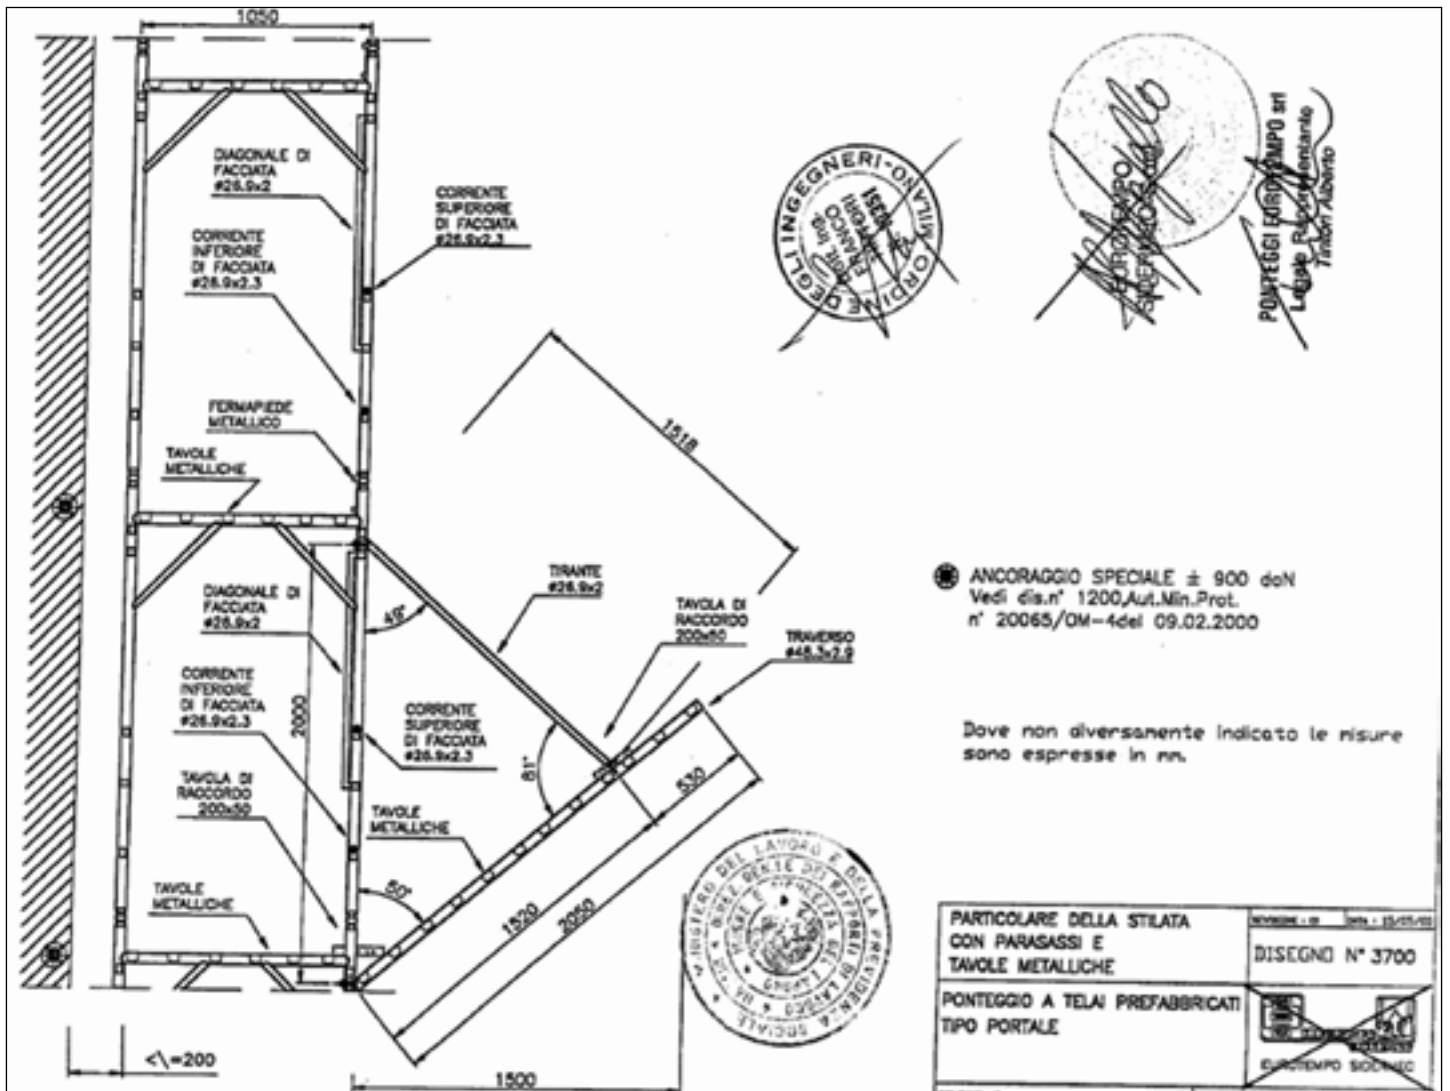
Particolare della stilata del ponteggio con elemento prefabbricato per la realizzazione della mantovana con aggetto da m. 1,5 e impalcati metallici al posto delle tavole in legno.
